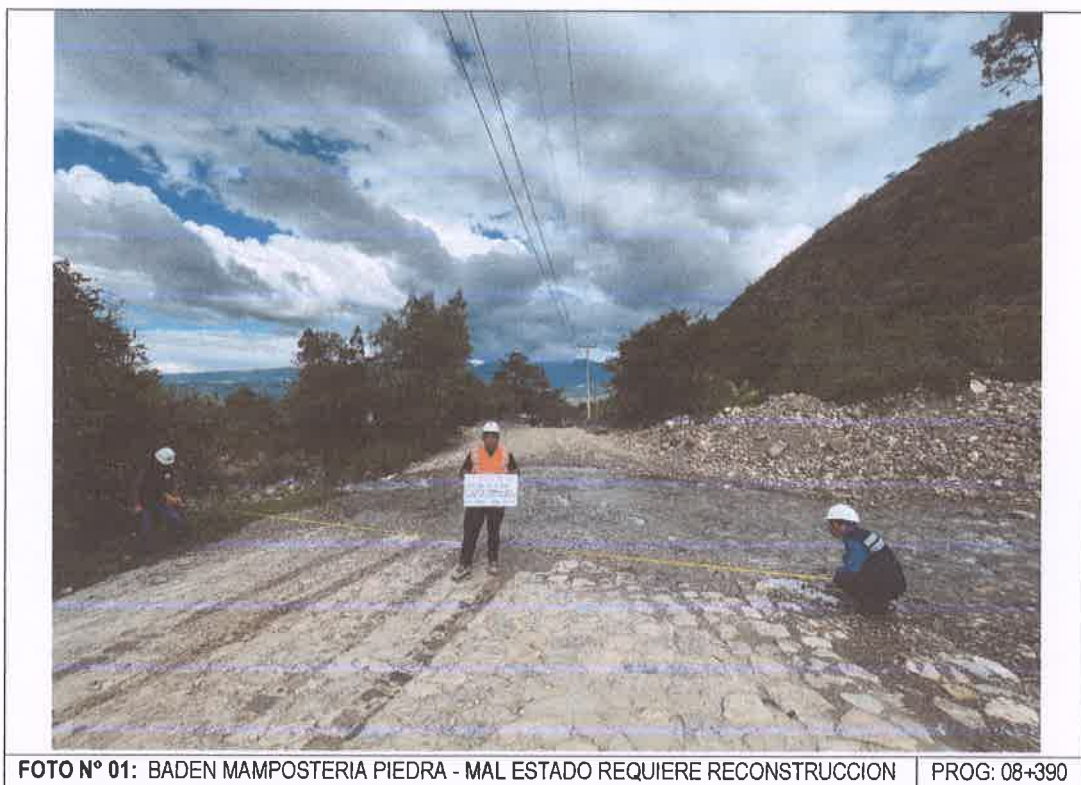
BADEN MAMPOSTERIA PIEDRA - MAL ESTADO REQUIERE RECONSTRUCCION | PROG: 08+390
